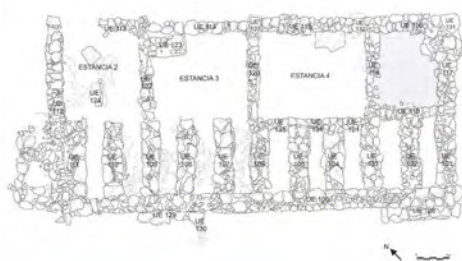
Planta y reconstrucción del almacén elevado de la Illeta dels Banyets (Olcina *et al.* 2009)
